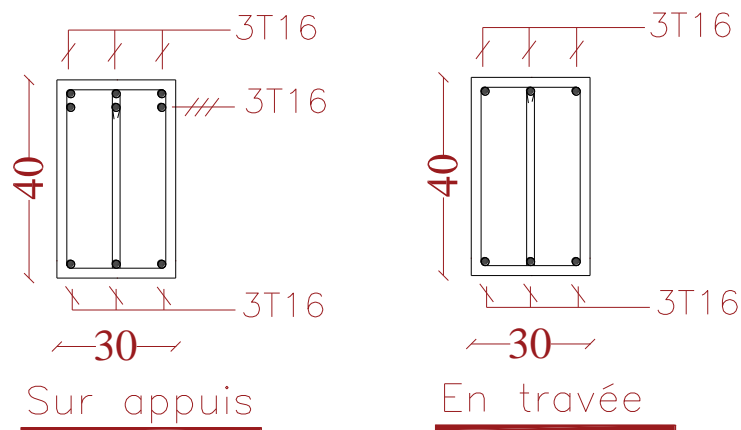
Coupe de ferrailage des poutres secondaires.
